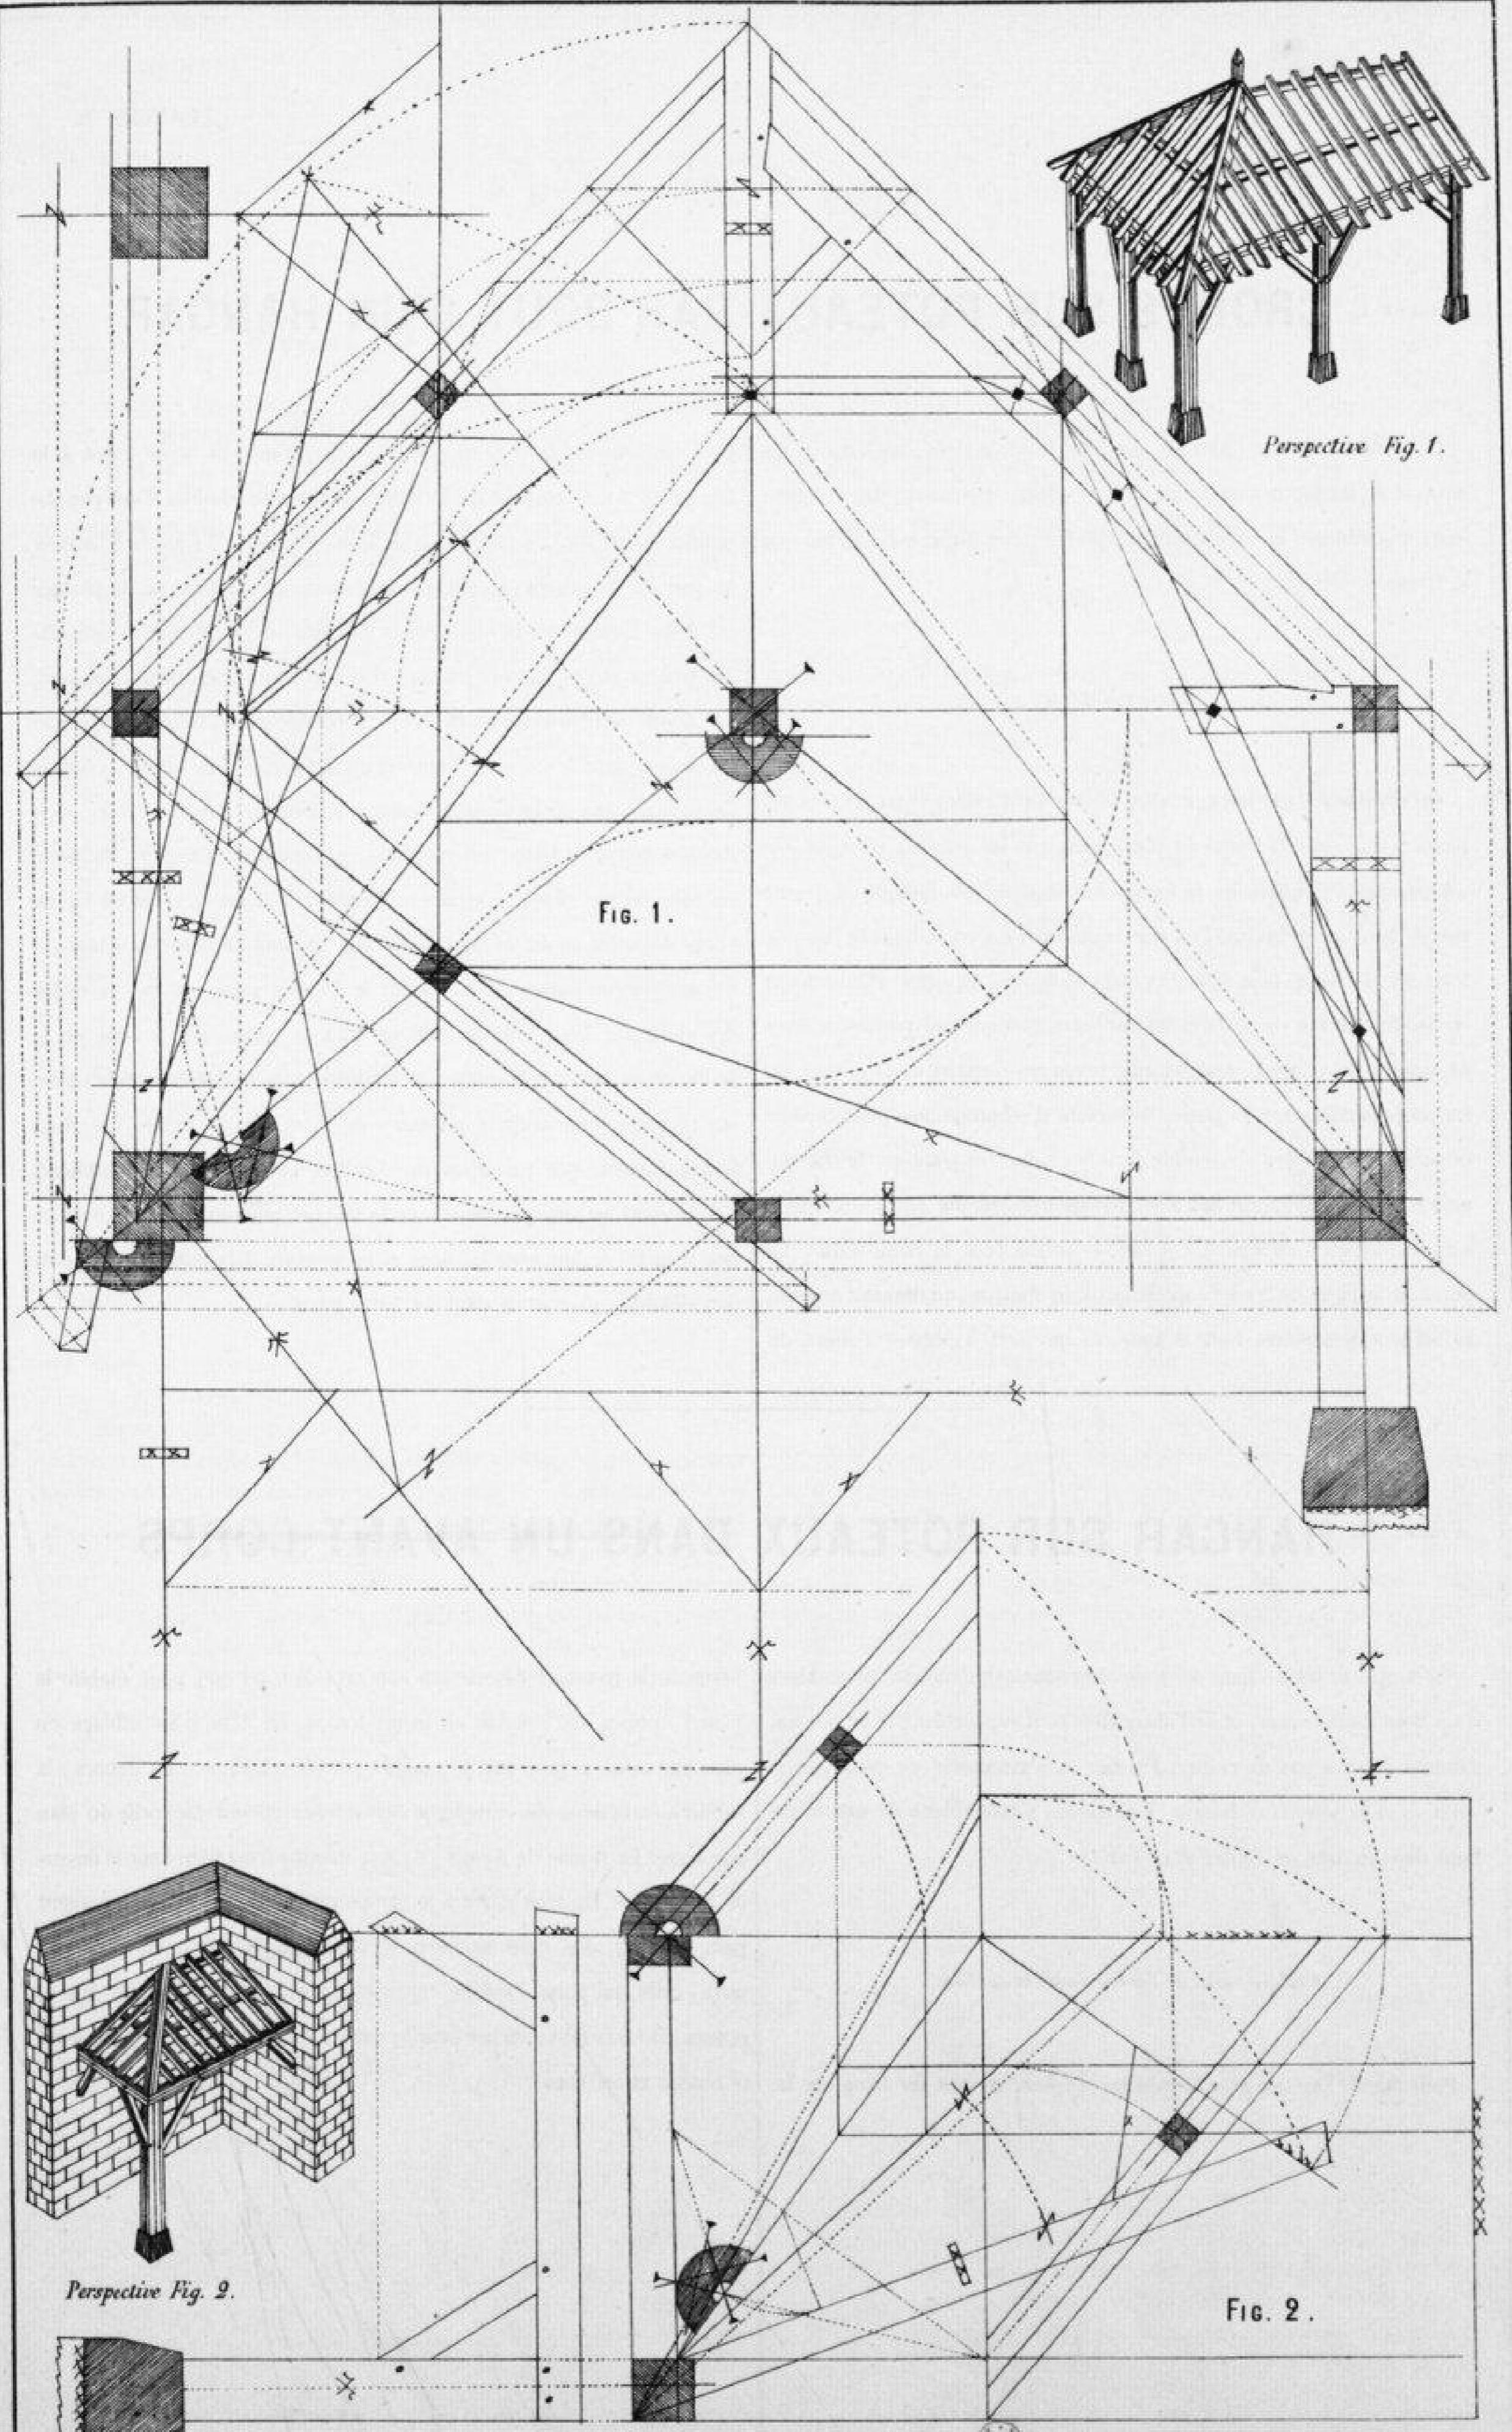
FIGURE II. HANGAR SUR POTEAUX DANS UN AVANT-CORPS
